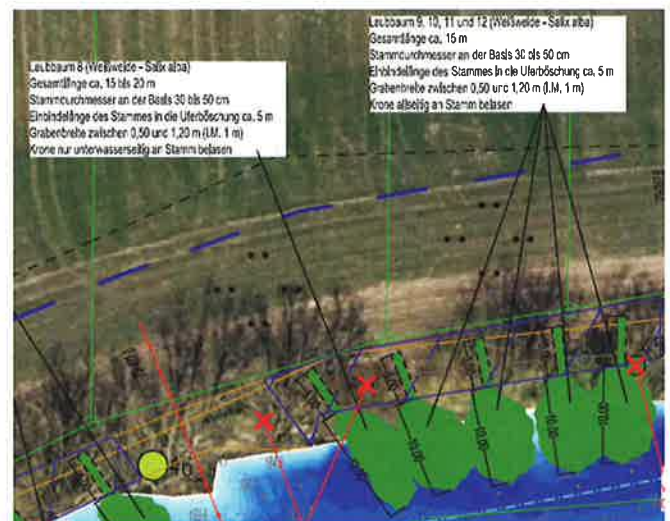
Detaildarstellung Einbauort 3 (Quelle: IPU Erfurt)
